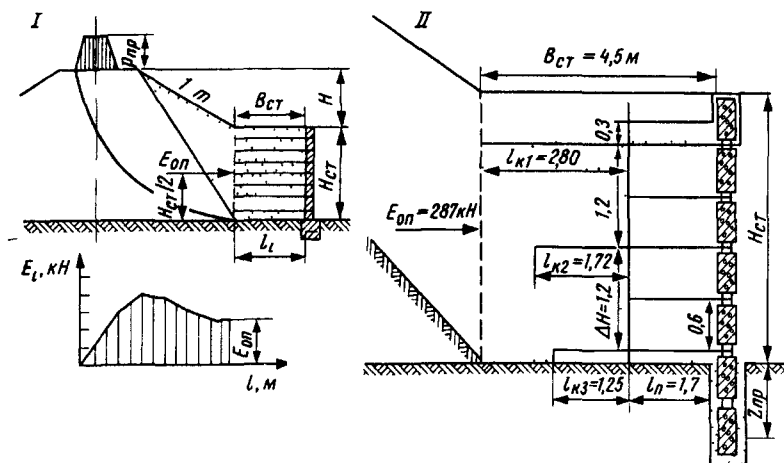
Схема проектирования армогрунтовой стены I — расчетная схема II — конструкция армогрунтовой стены (Размеры в м)
